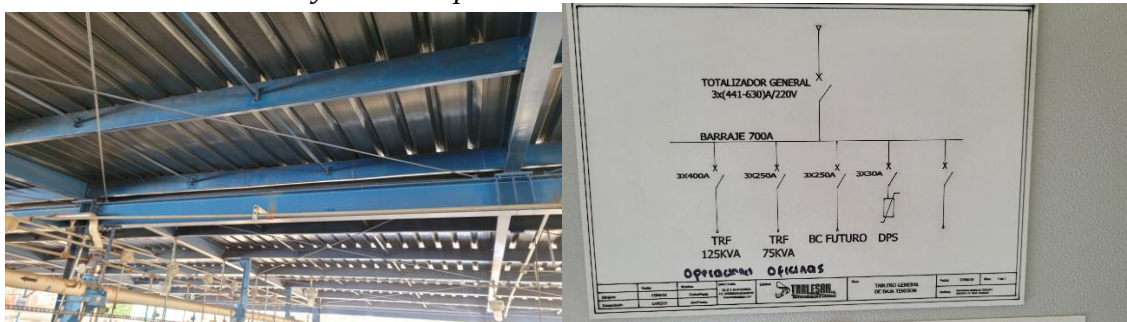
Revisión estructural cubierta para instalación en planta Totto*Figura 10. *Revisión técnica eléctrica en planta Totto*Figura 11. *Revisión estructural y eléctrica planta de llenado Chimita
